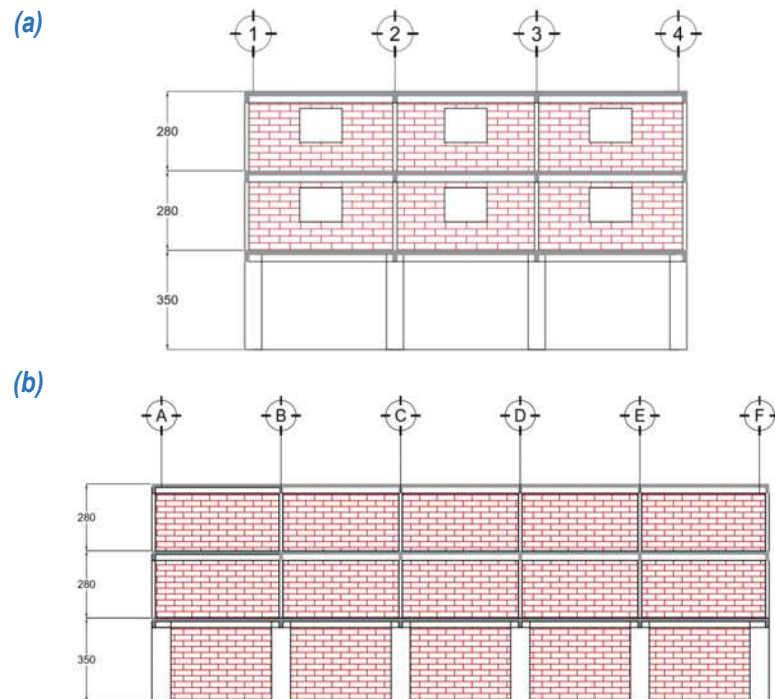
Estructuración en alzado propuesta en modelo 1: (a) fachadas frontal y posterior, y (b) fachadas laterales (Acotaciones en centímetros).
